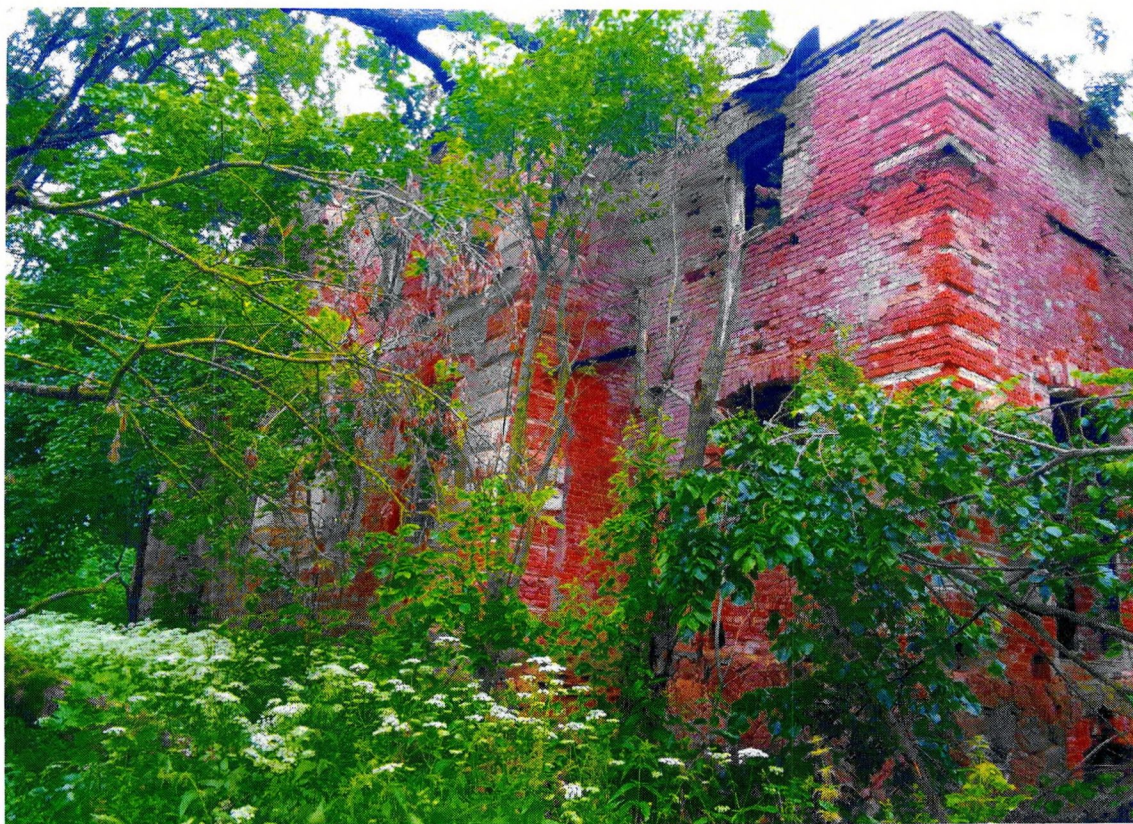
«Главный дом». Южный фасад. Утраты штукатурного слоя, механические повреждения кладки, выпадение кирпичей из кладки.
